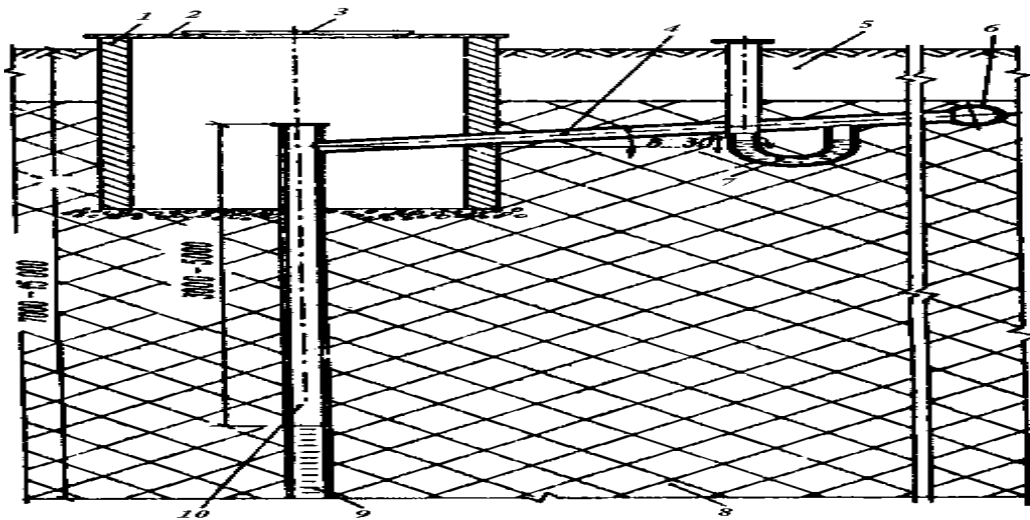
Повздовжній розріз вертикальної газозбірної свердловини [5]
